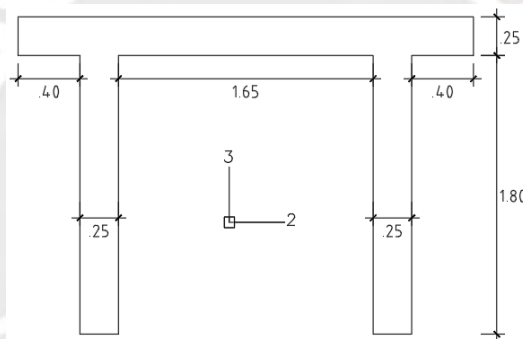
Sección transversal y orientación de ejes locales de la placa PL-02.
